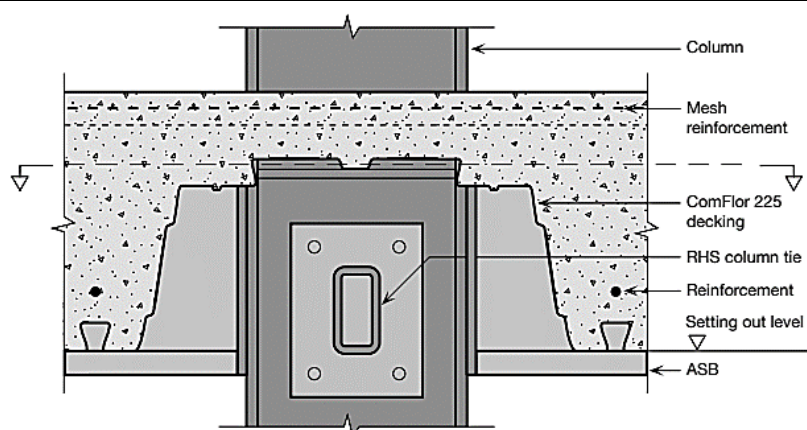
Exemplo de aplicação de Column Tie (Tata Steel, 2007).
